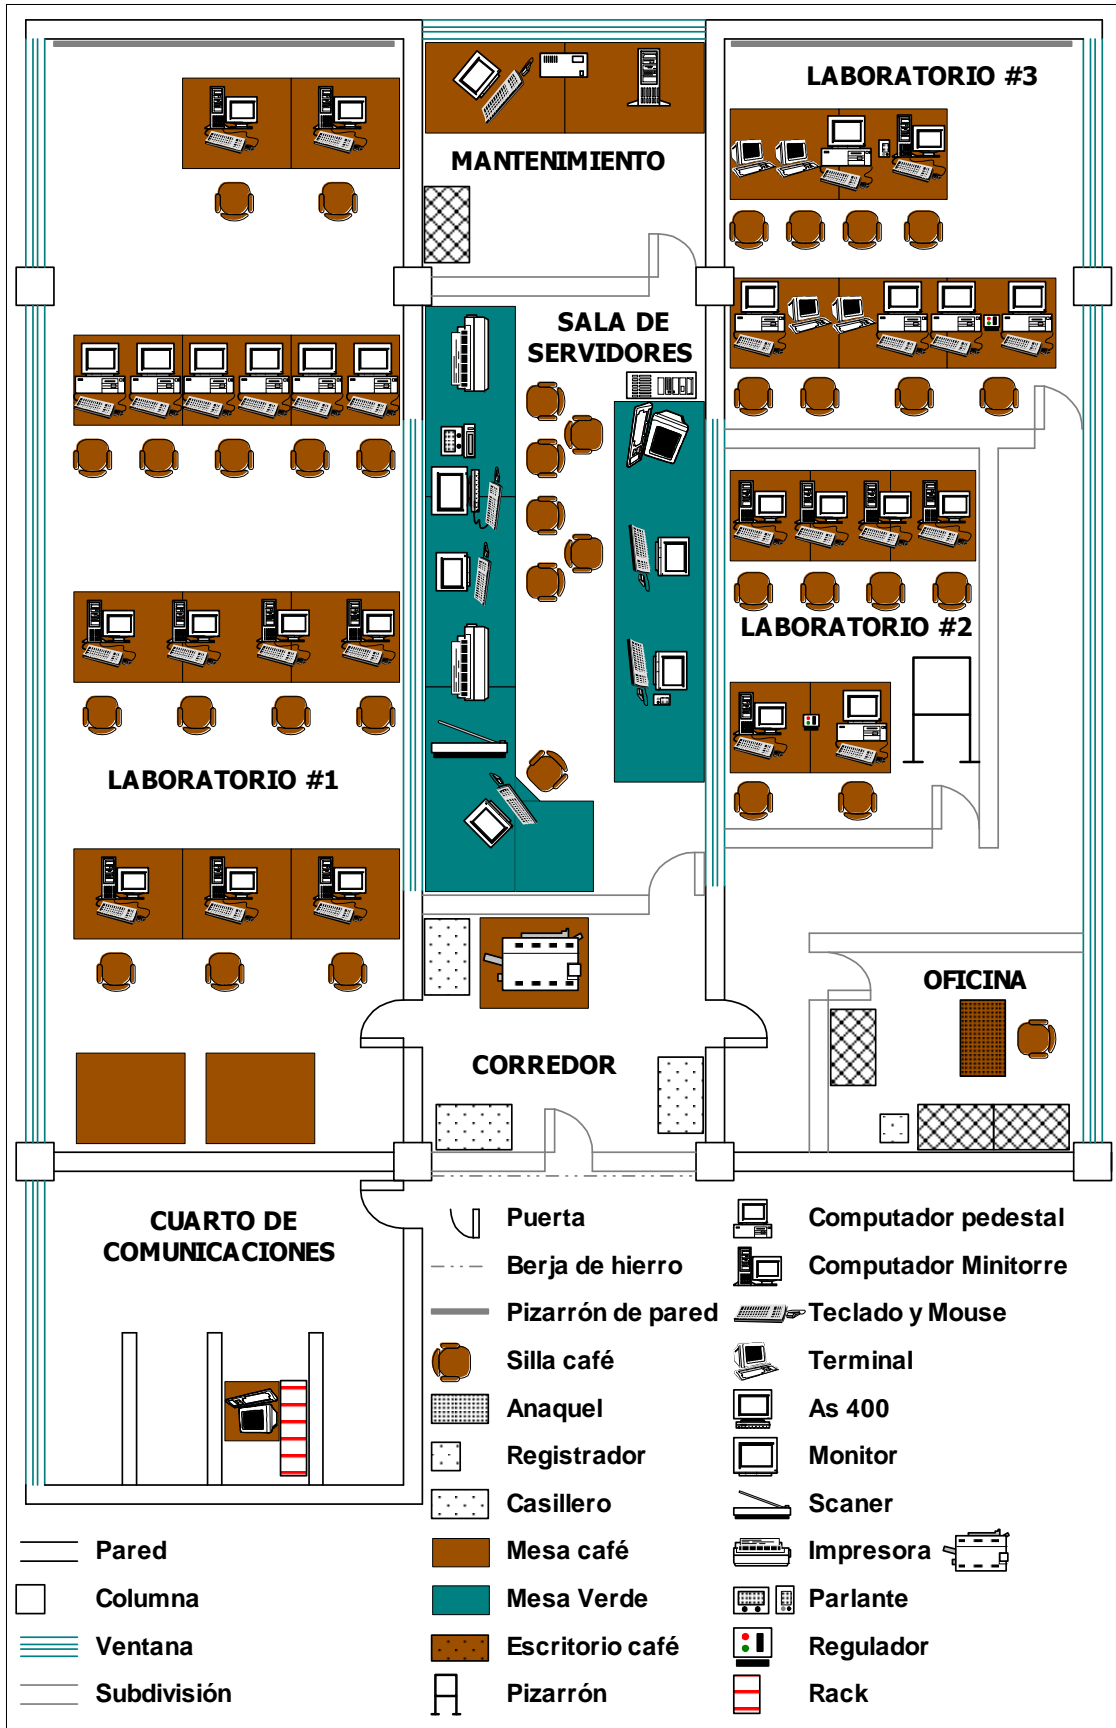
Plano del Laboratorio Virtual de la FICA
